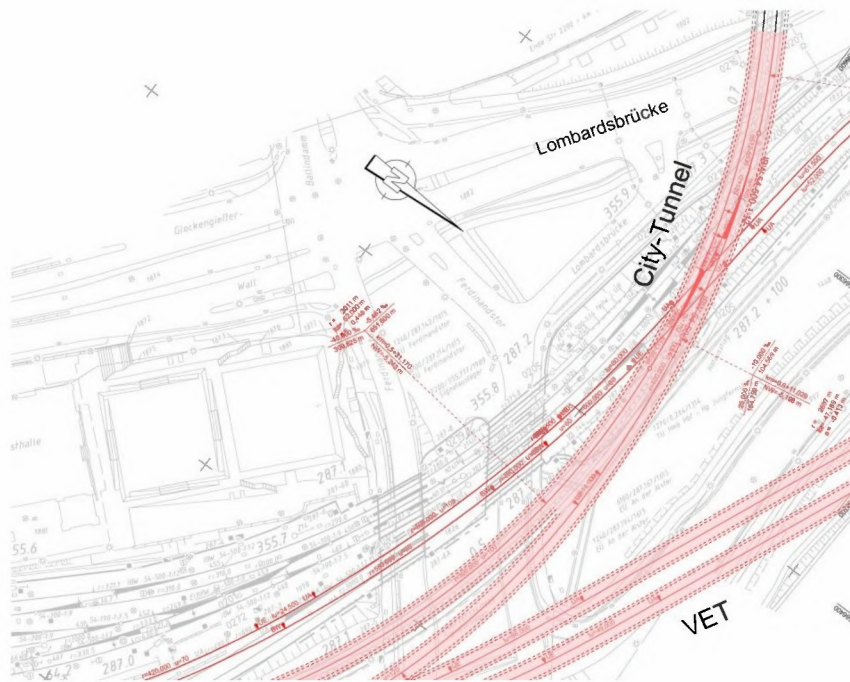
Lageplan Variante 3 – Anpassung City-Tunnel
